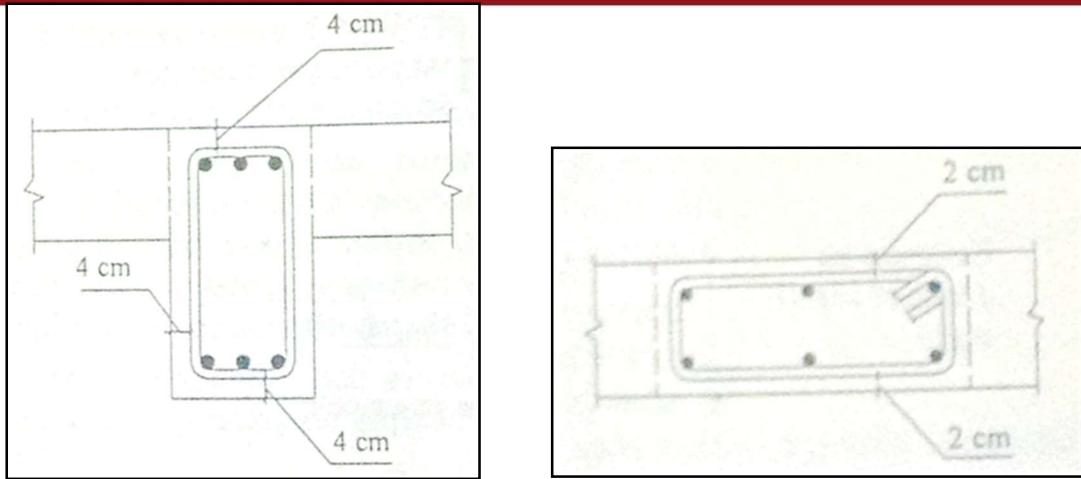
Recubrimiento en Vigas Peraltadas y Vigas Chatas. (Fuente: Apuntes del Curso Concreto Armado 1, Ottazzi 2010).
